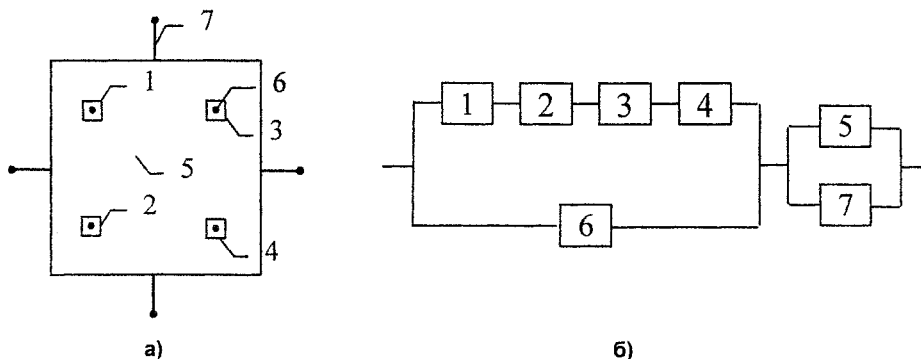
Конструктивная схема (а) и расчетная модель надежности (б) элементарной ячейки монолитного здания: 1–4 – колонны; 5 – плита перекрытия; 6 – вертикальные связи; 7 – горизонтальные связи
